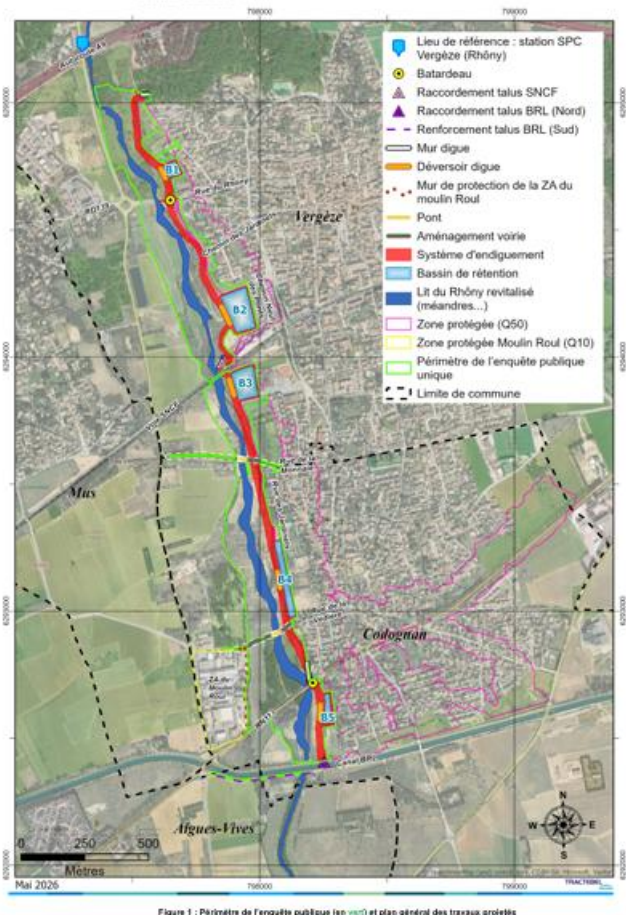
Périmètre de l'enquête publique (en vert) et plan général des travaux projetés
